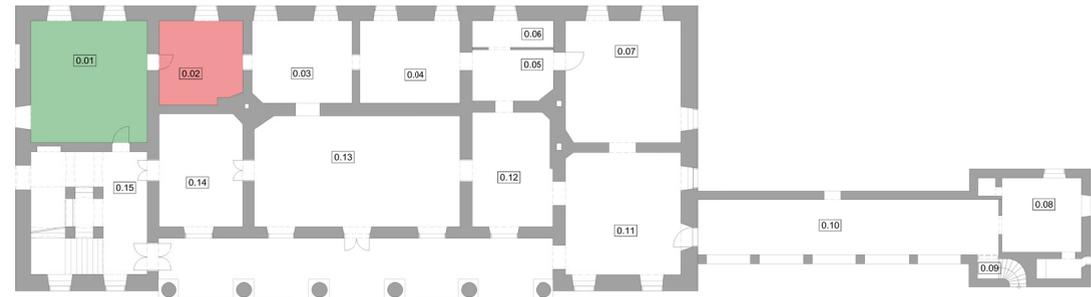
Grundriss Deckenzustand EG, 2015
